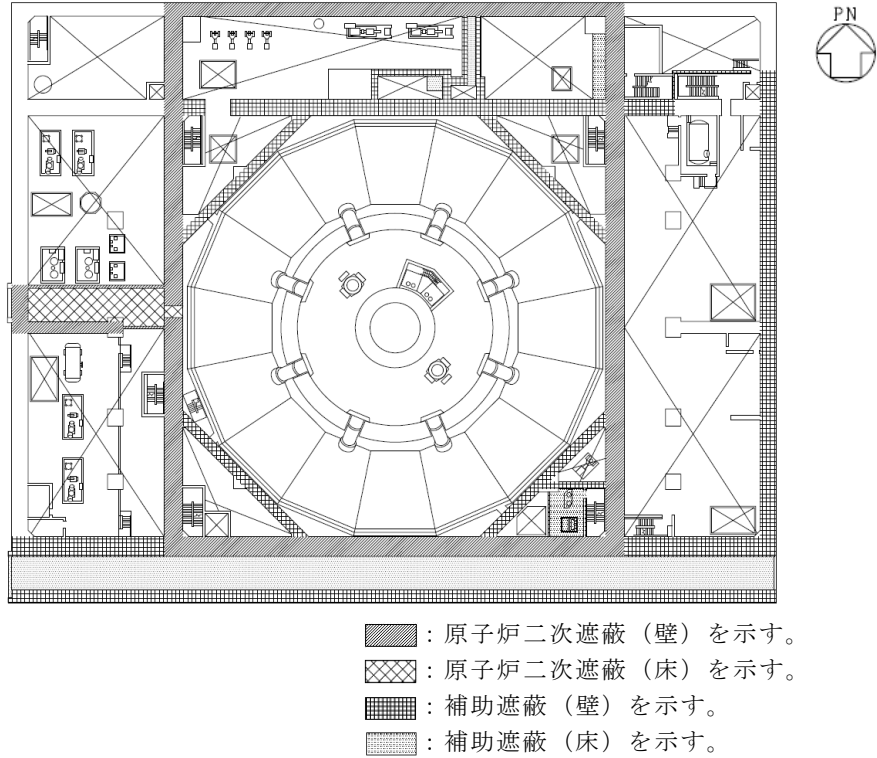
(3) 原子炉二次遮蔽及び補助遮蔽（原子炉建物）の範囲の平面図
